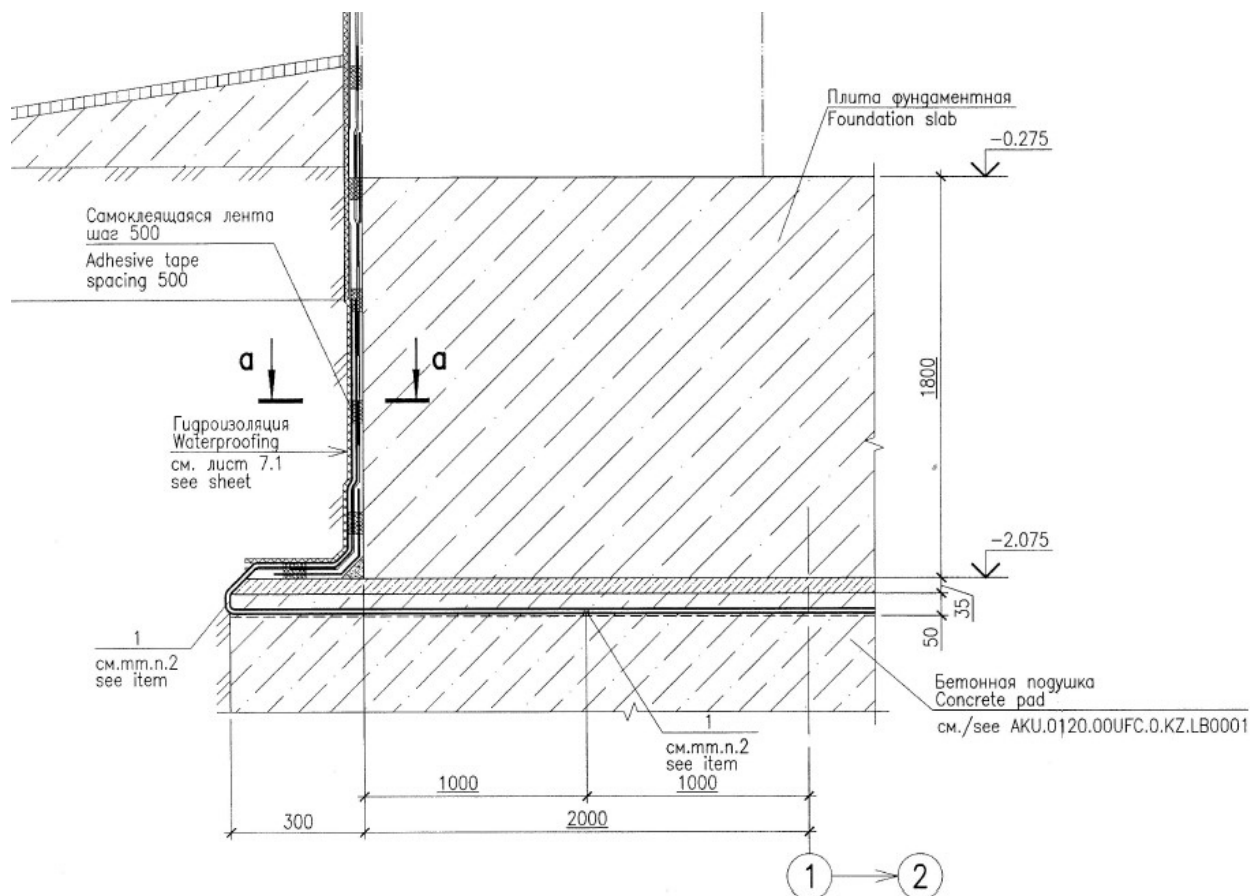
Схема устройства основания здания с гидроизоляцией из сталефибробетона
